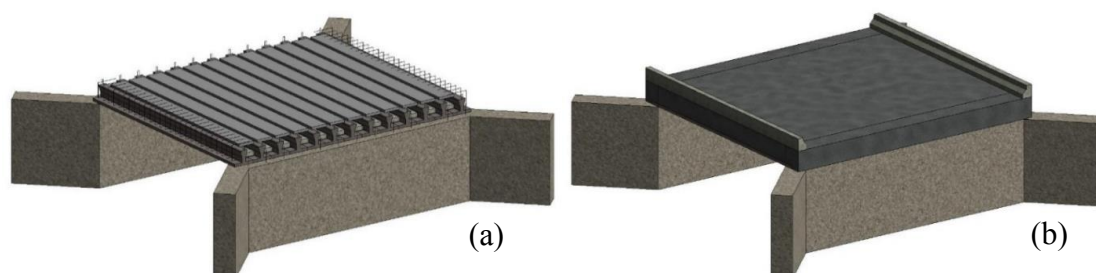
(a) Elementos pré-fabricados e (b) concreto de cobertura da ponte de concreto pré-fabricado. Fonte: elaborado pelos autores.
